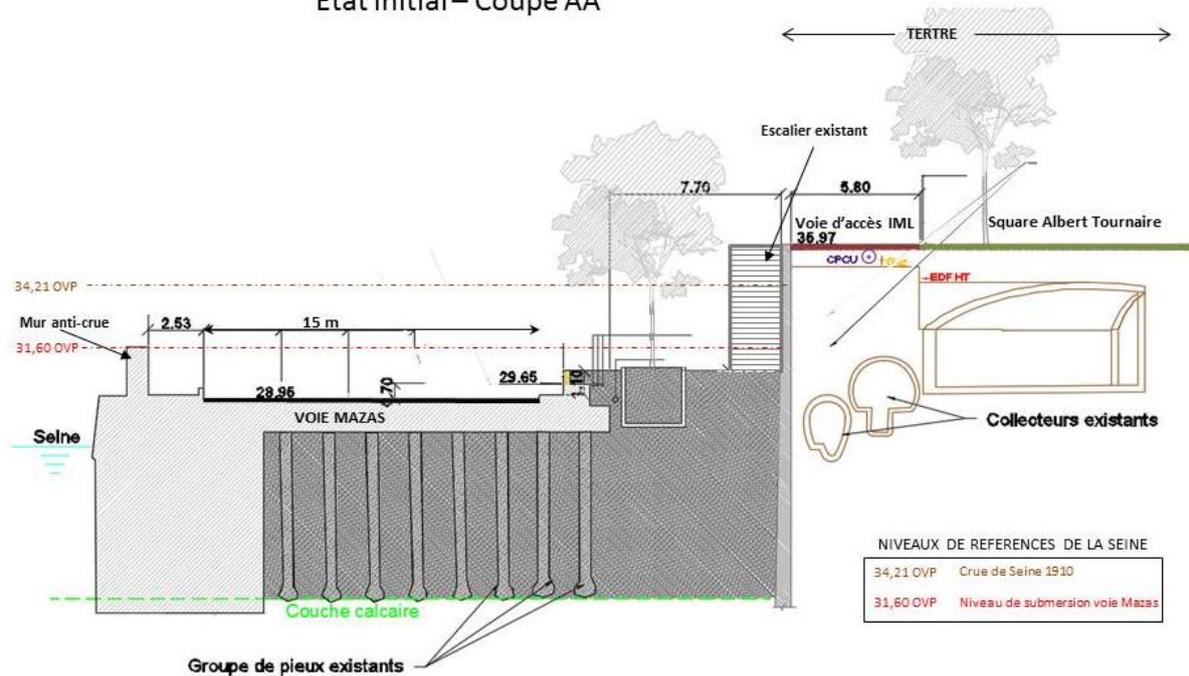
Coupe sur la situation actuelle des ouvrages existants sur la voie Mazas
